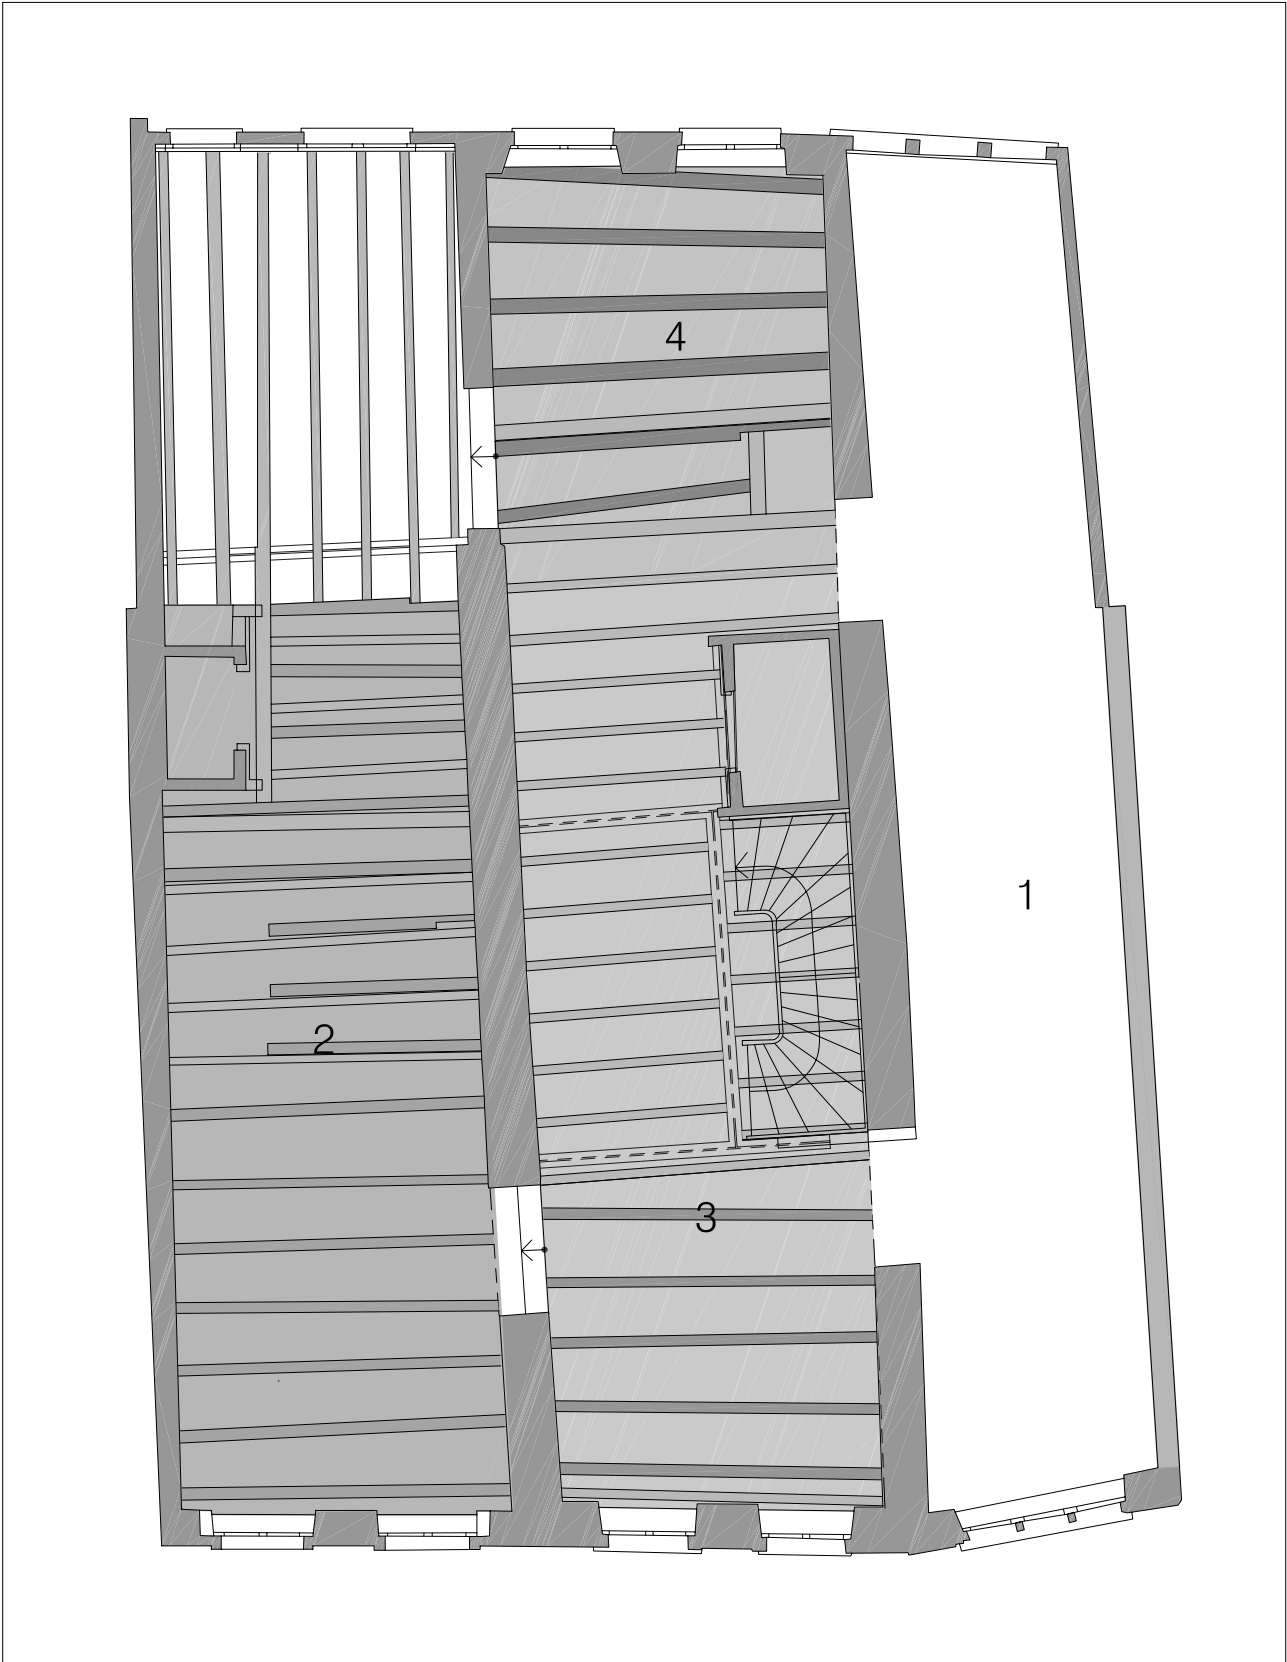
Gerbergasse 71, 73, und 75 (2003 /410), Grundriss 1. Obergeschoss mit den Dendro-Datierungen; Gerbergasse unten. Maßstab 1:200. – Zeichnung Werner Bäßler, Bearbeitung Clemens Staub.
